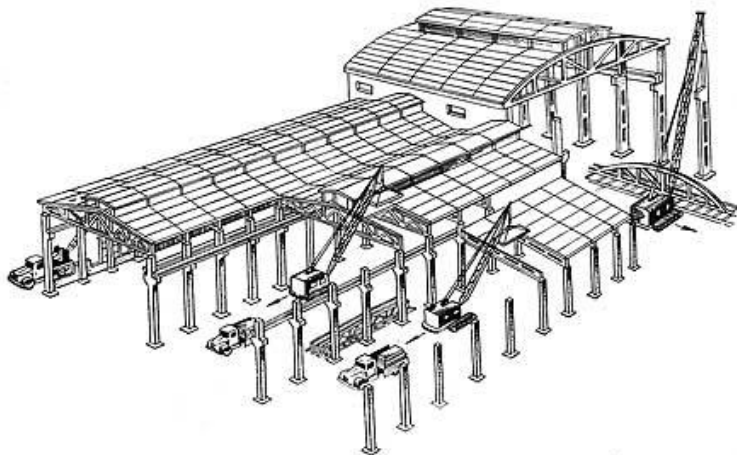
Схема монтажа конструкций покрытия одноэтажного промышленного здания (монтаж ведется тремя потоками)
